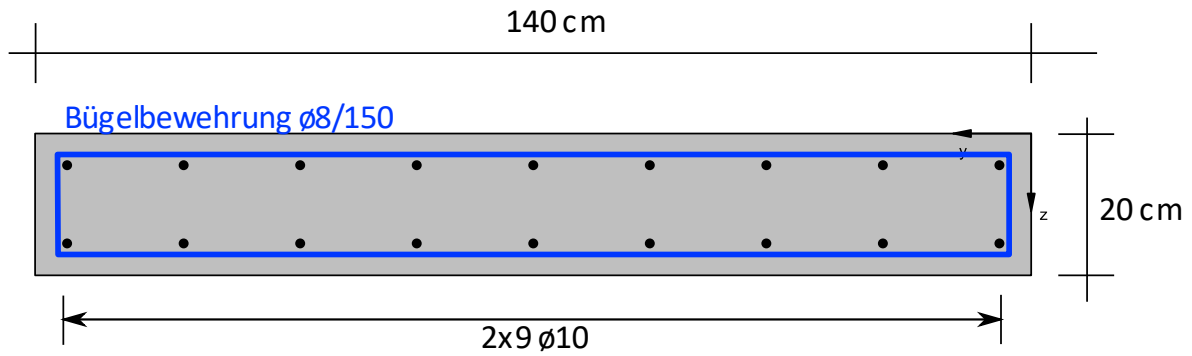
Geschätzte Bewehrung Wandscheibe BW1
